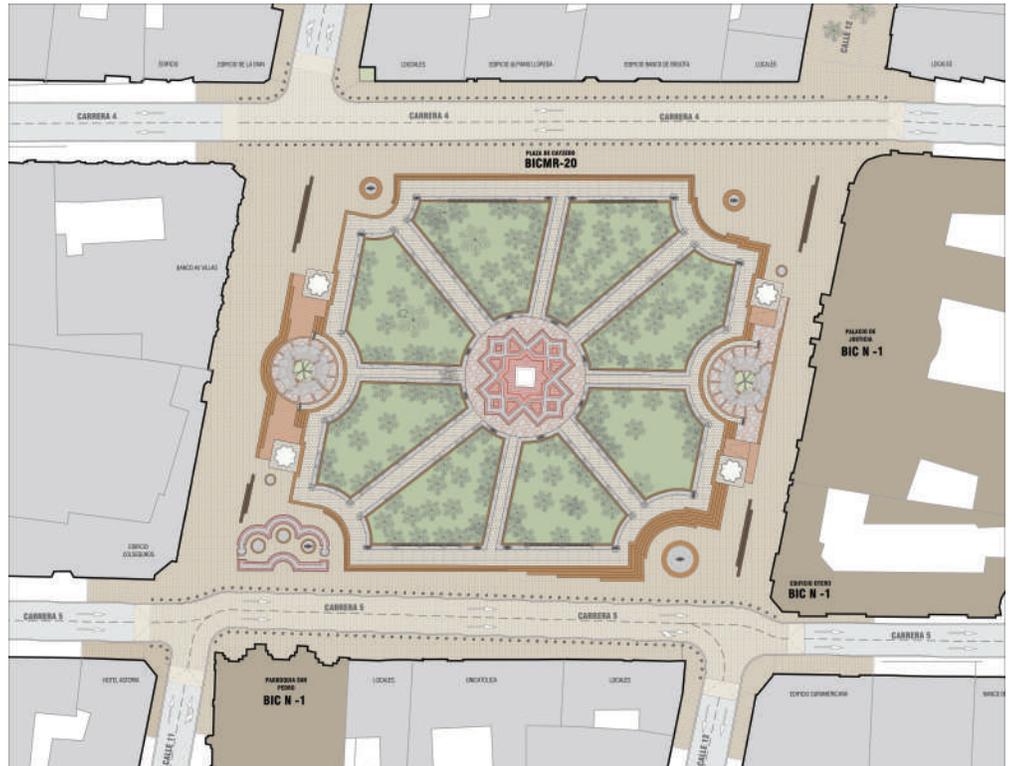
Planta propuesta para la intervención de la Plaza Caycedo. Fuente: TEP, 2023.
